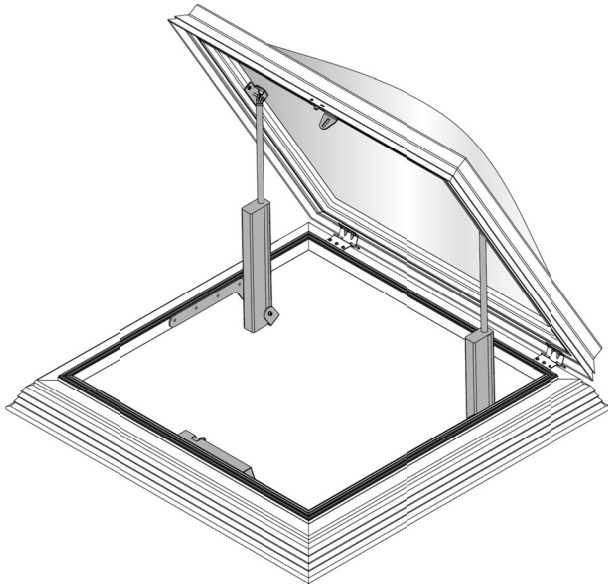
Spindelantriebe Dachausstieg Typ M < 125 cm
